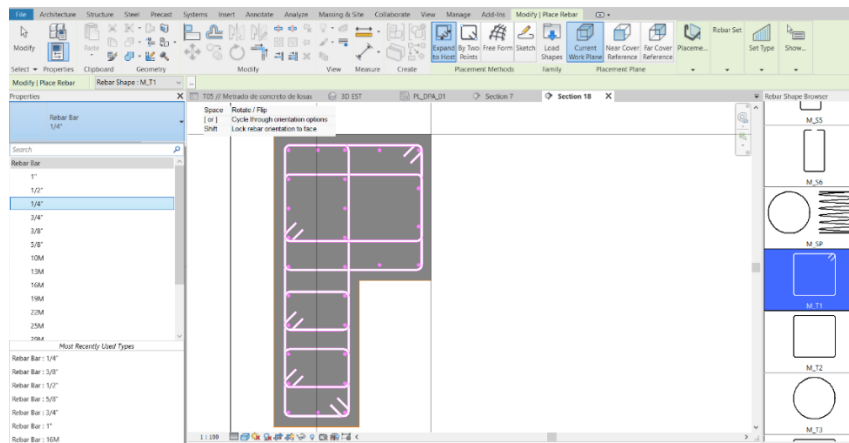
Colocación de estribo en columna C7 de área tareas previas en DPA
